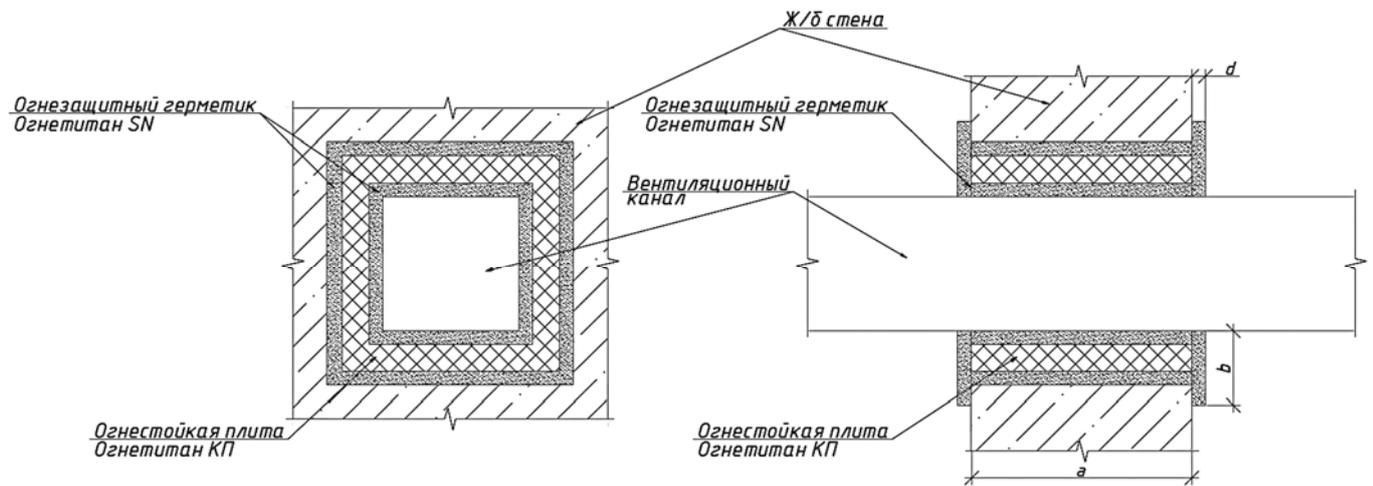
Огнестойкая заделка вентиляционных проходок прямоугольного сечения
